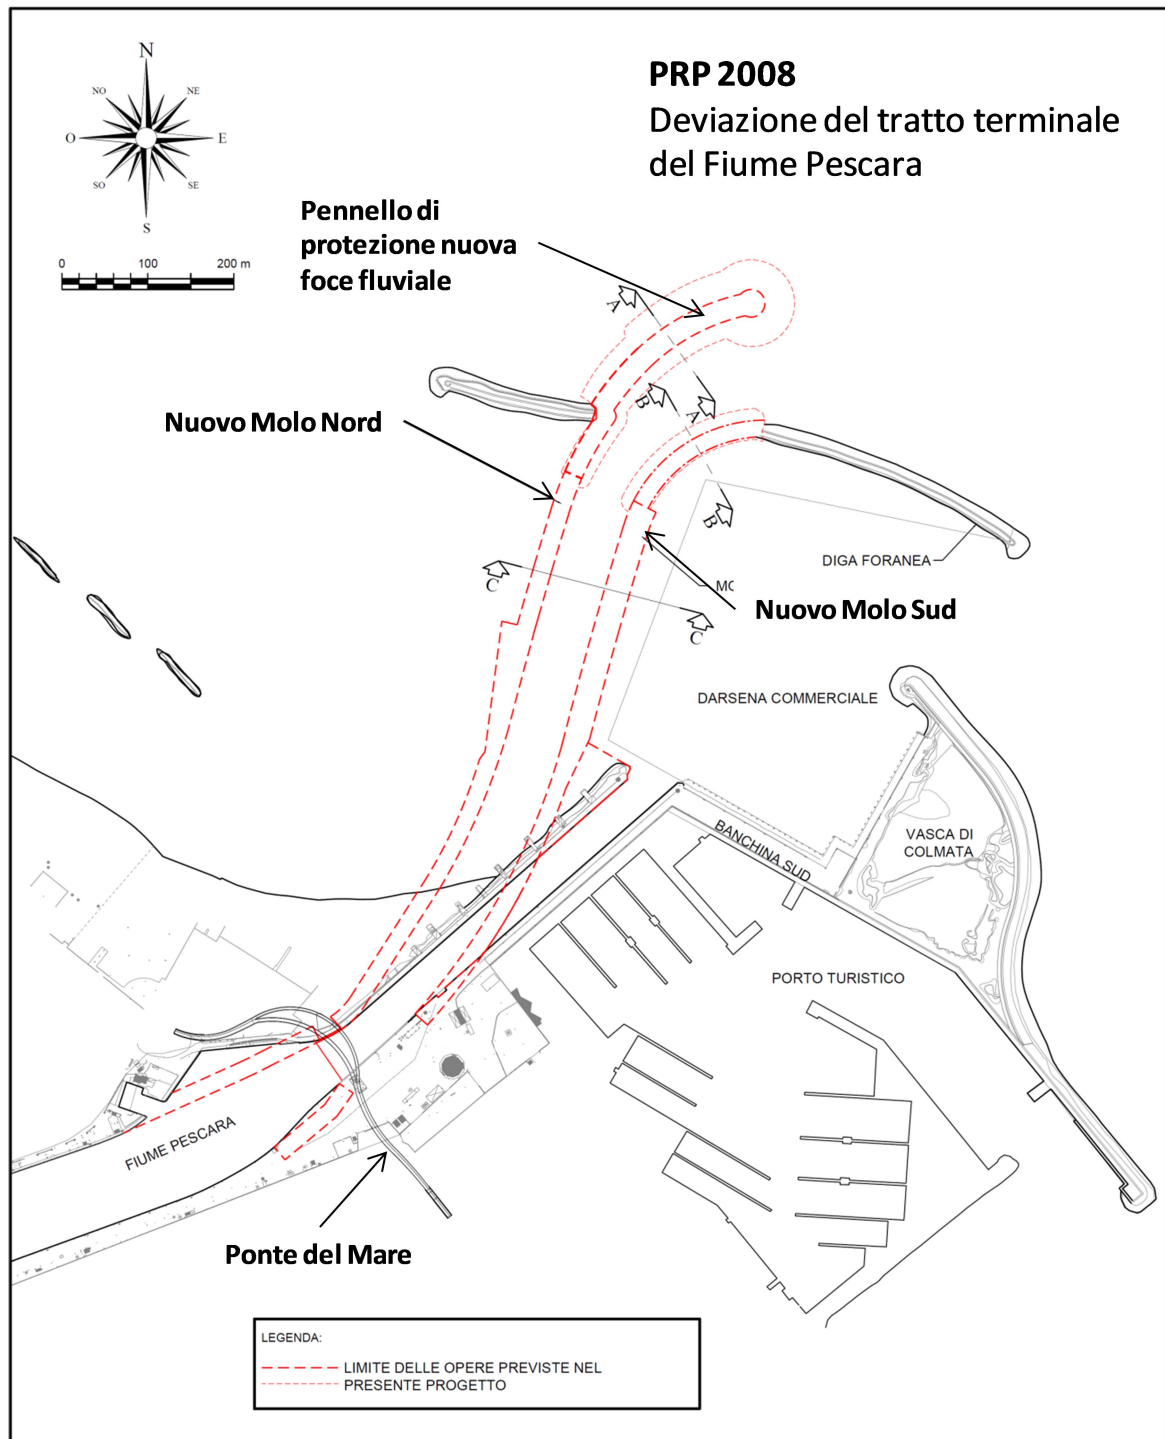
OPERE PREVISTE DAL DOCUMENTO PRELIMINARE ALLA PROGETTAZIONE IN ATTUAZIONE DEL PRP 2008
